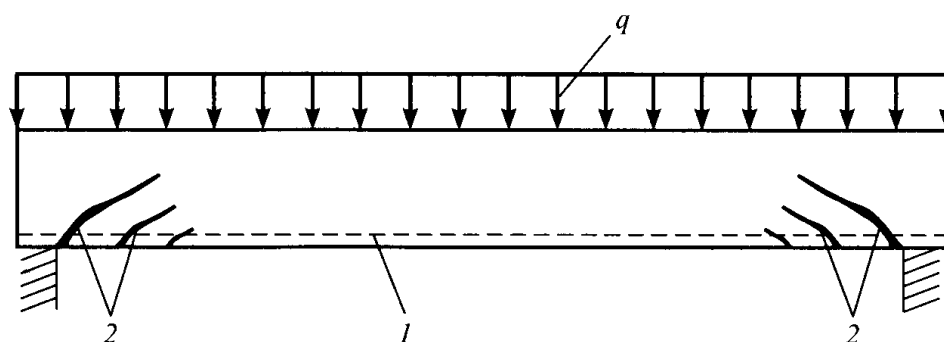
Оценка повреждений железобетонных конструкций по образованию и раскрытию наклонных трещин:
